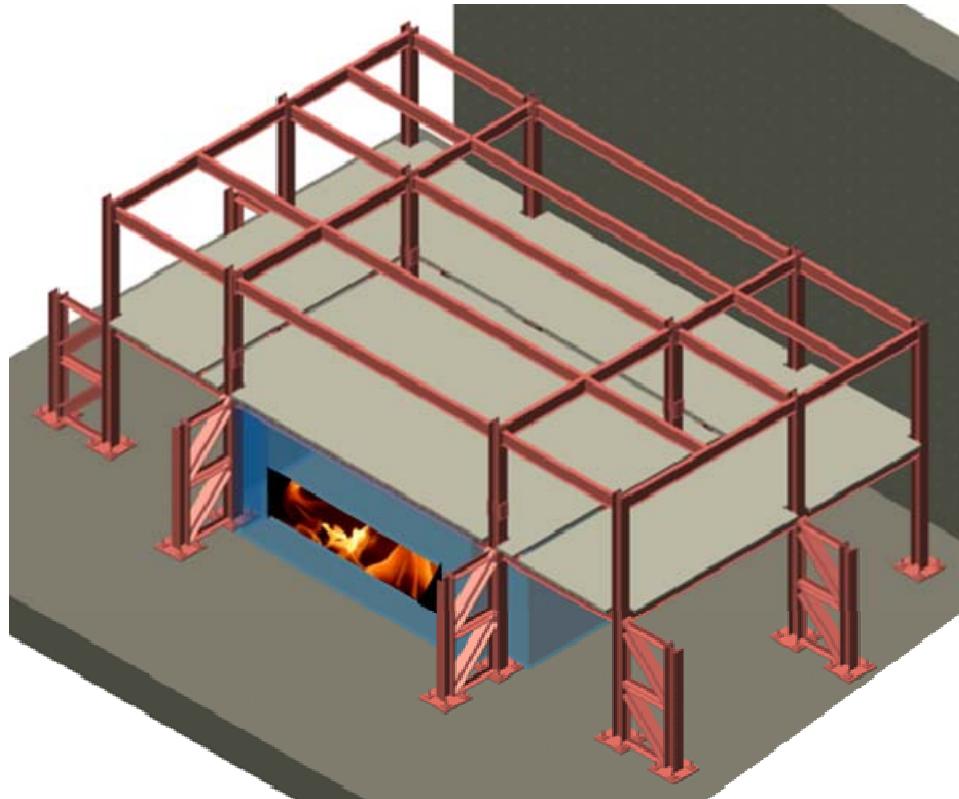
美國 NIST 鋼筋混凝土樓版複合結構實驗屋(參考書目[28])
